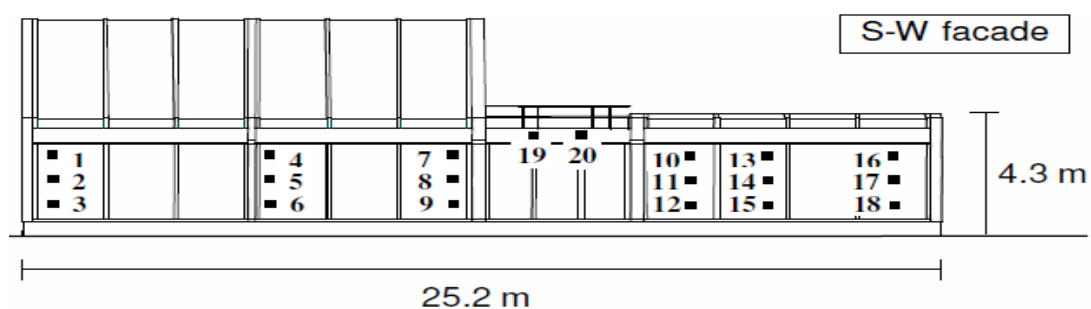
Esquema de colocação dos pluviómetros na fachada de Sudoeste [16]
